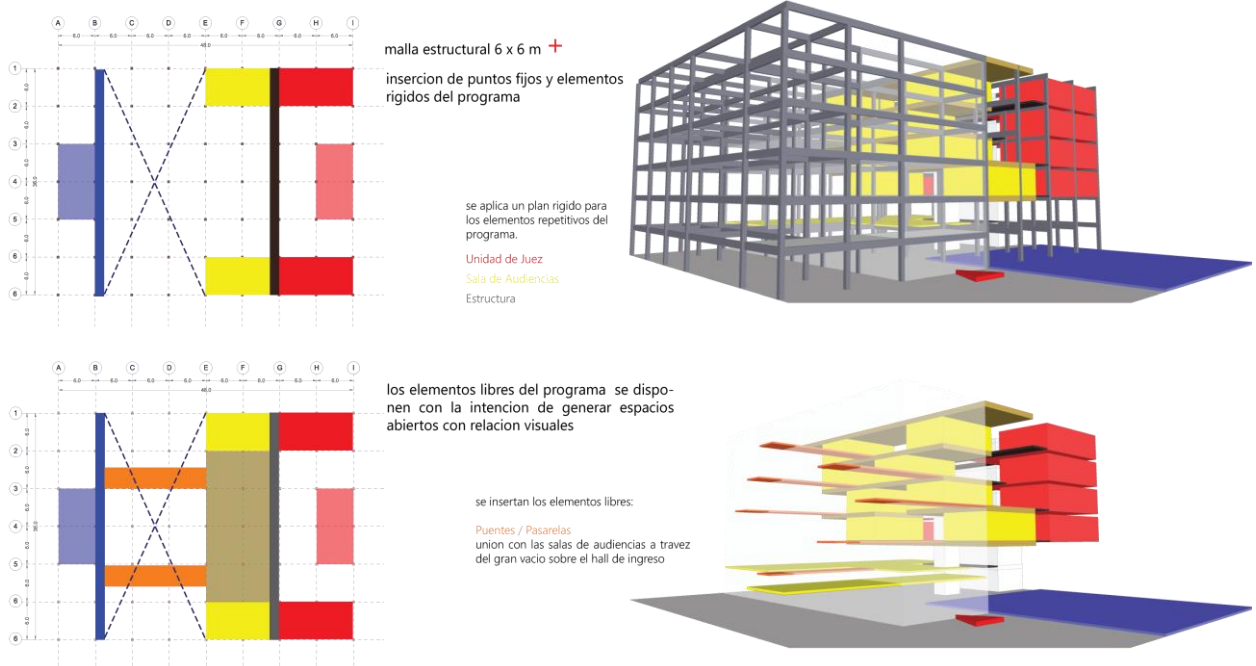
Esquemas de organización espacial. Plan Rígido vs. Plan Libre
